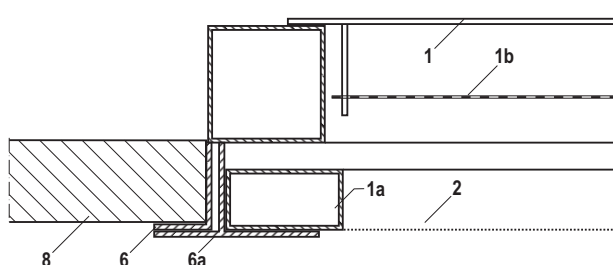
Luftdurchlaßgehäuse 1 deckenintegriert eingebaut, Zwischendecke 8 umlaufend auf Deckenanschlußwinkel 6 aufgelegt; unterer Abschluß durch Rahmen 6a
